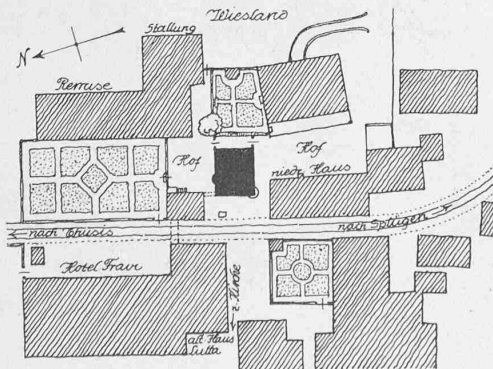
Lageplan zum Haus Fravi, Andeer. — Masstab 1:2000.
